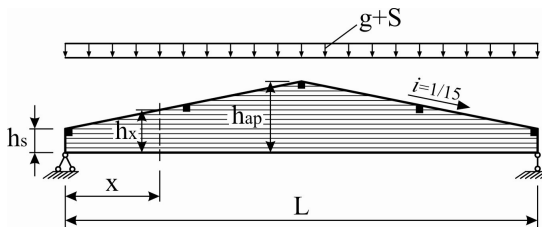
Схема навантаження балки та місця розкріплення верхнього пояса
